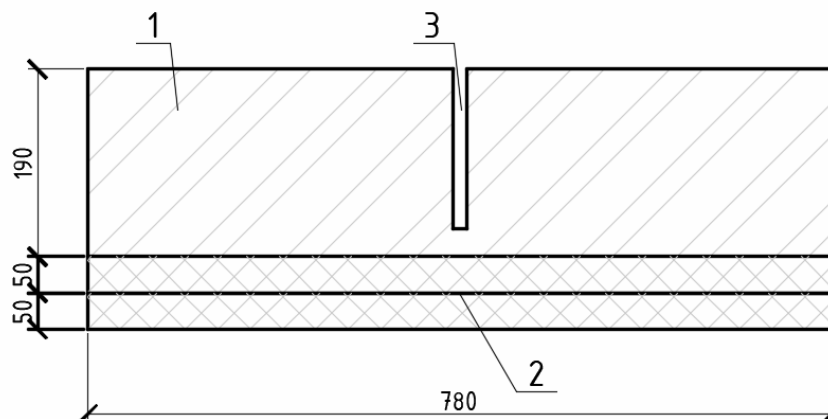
Схема сечения стены по кладке со 100 мм утеплителя с дефектом
